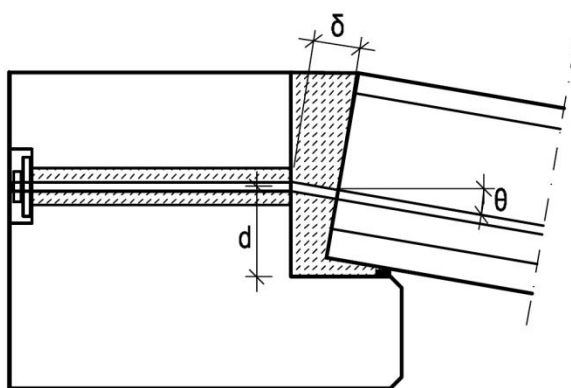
esitetään betonikonsoliin tuetun palkin ja pilarin välisen liitoksen toiminta negatiiviselle taivutusmomentille kun sideteräkset on sijoitettu palkin päällä olevaan paikallavaluun ja ankkuroitu pilariin. Sideteräksen voimasta ja betonin puristuksesta syntyvän voimaparin lisäksi liitoksessa vaikuttaa liitoksessa sijaitsevan tappin vedon ja konsolin betonissa sijaitsevan puristuksen muodostama voimapari. Tämän voimaparin tuoma lisäkapasiteetti voidaan käyttää hyväksi, jos tappi on ankkuroitu riittävän hyvin, mutta sen tuoma kapasiteetti on pieni verrattuna sideteräksen muodostamaan kapasiteettiin, koska momenttivarsi on hyvin pieni. Liitoksen kapasiteetti lasketaan tavallisen betonipoikkileikkauksen tapaan. Betonin puristuslujuutena käytetään jälkivaletun betonin lujuutta. Tarkasteltaessa liitoksen kapasiteettia positiivisille taivutusmomenteille, muodostuu liitoksen vetokapasiteetti konsolin tappin leikkauskapasiteetista. Ongelmana tämän kapasiteetin hyödyntämisessä jatkuvan sortuman hallinnassa on, ettei tappiliitoksella ole riittävää sitkeyttä eikä muodonmuutoskykyä. Näin ollen jatkuvuus positiivisille taivutusmomenteille on syytä muodostaa muilla tavoin.
